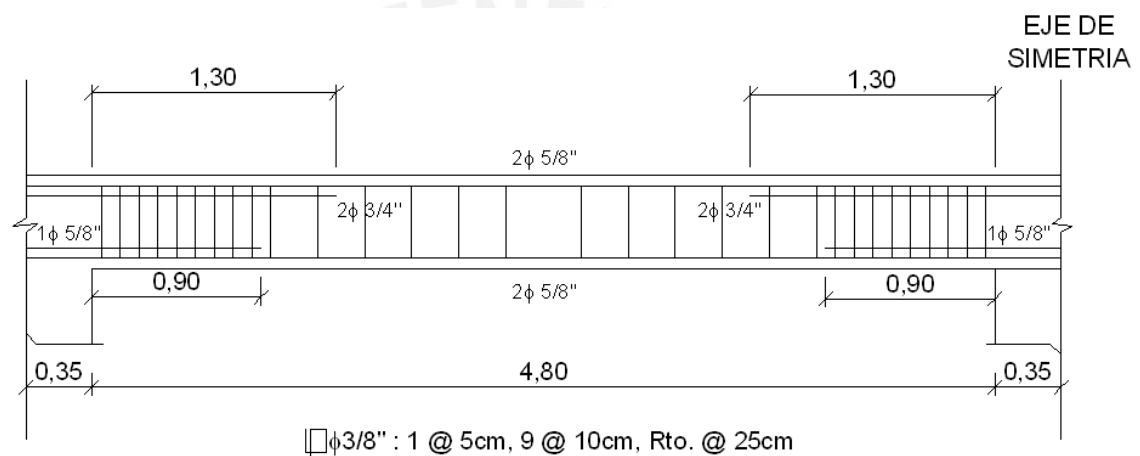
Armadura de una viga longitudinal típica de 25x50
